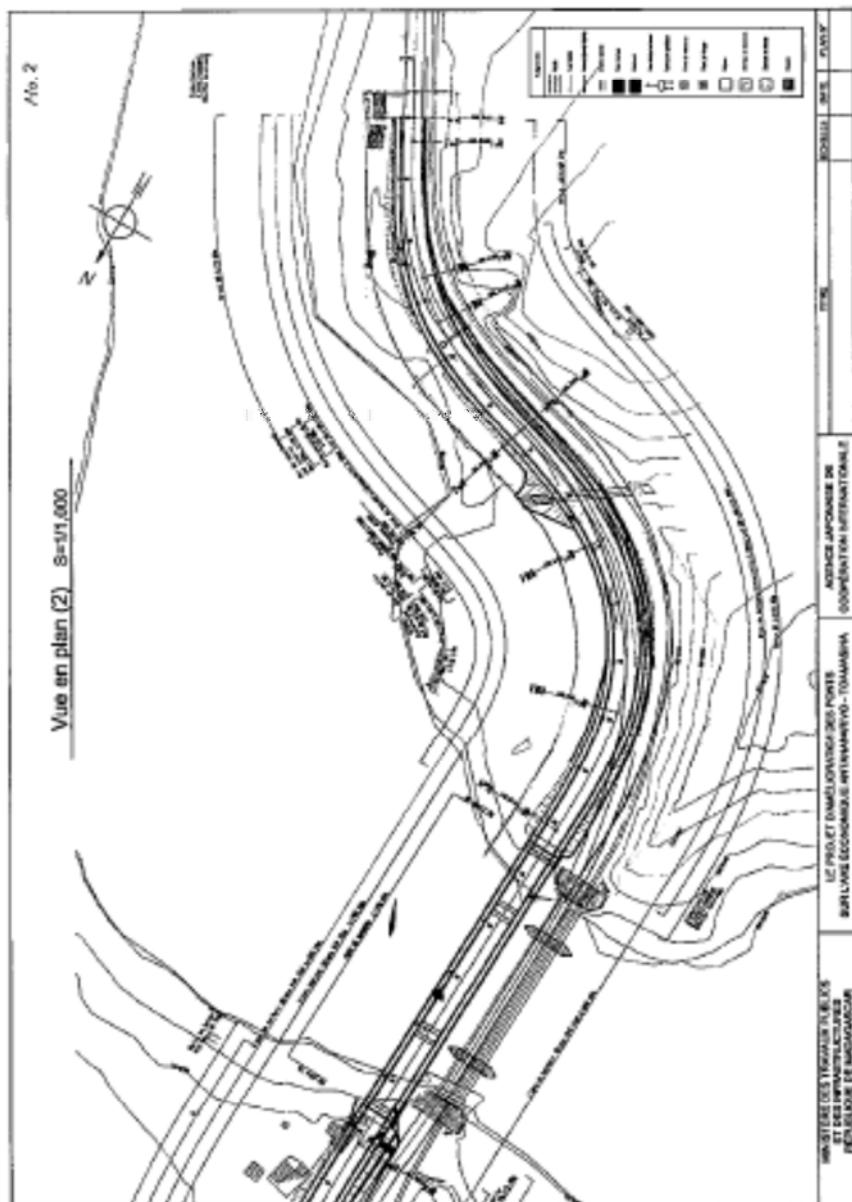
PLAN FINAL POUR MANGORO = PARTIE 2
